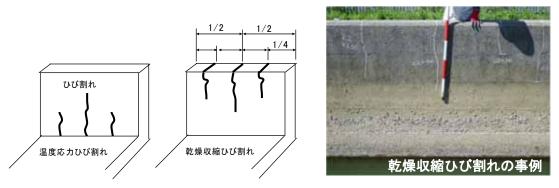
乾燥収縮・温度応力ひび割れ発生位置
